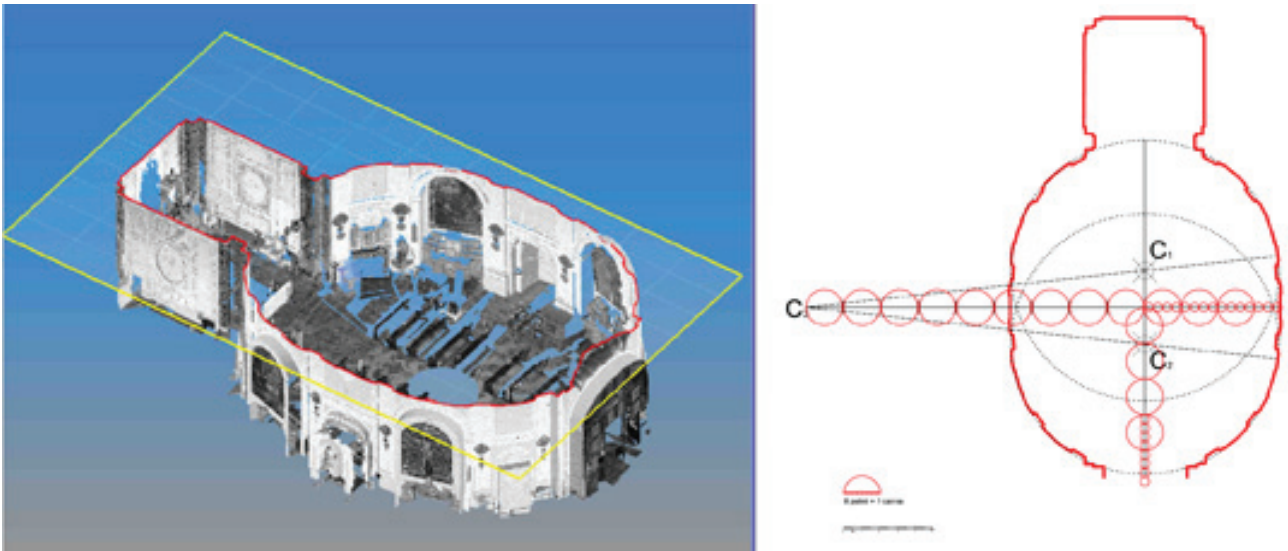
(a sinistra) individuazione del piano sezione su cui condurre lo studio geometrico; (a destra) studio geometrico dell'impianto planimetrico.
